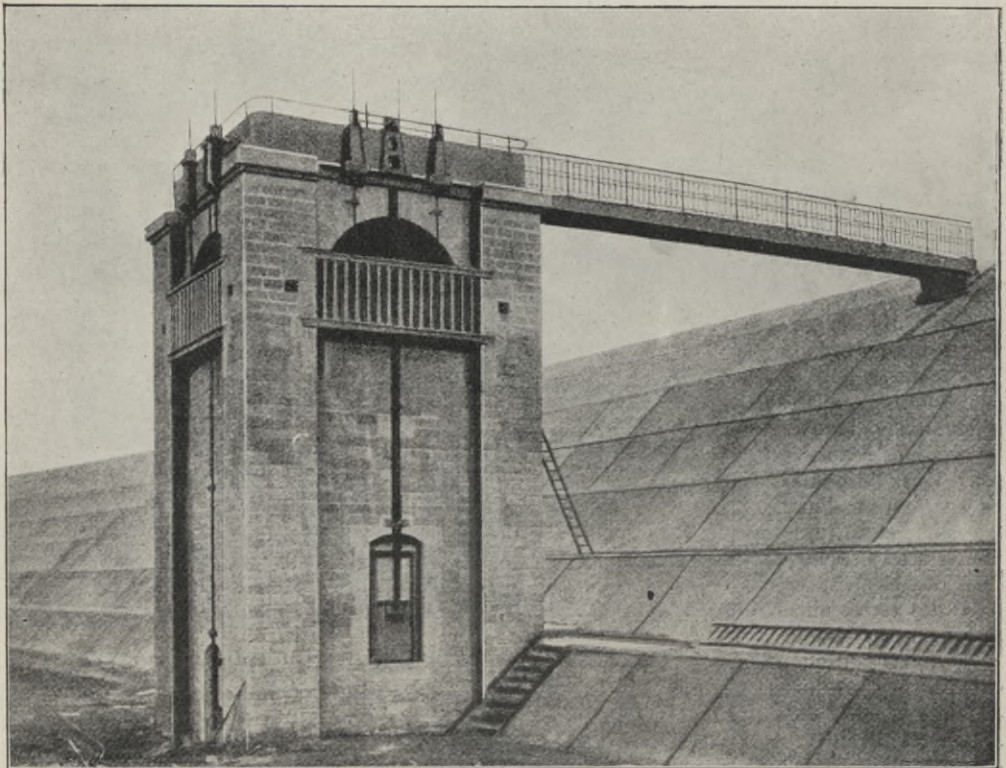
Ansicht der Betonböschung nebst Entnahmeturm am Staudamm von Villegusien.
